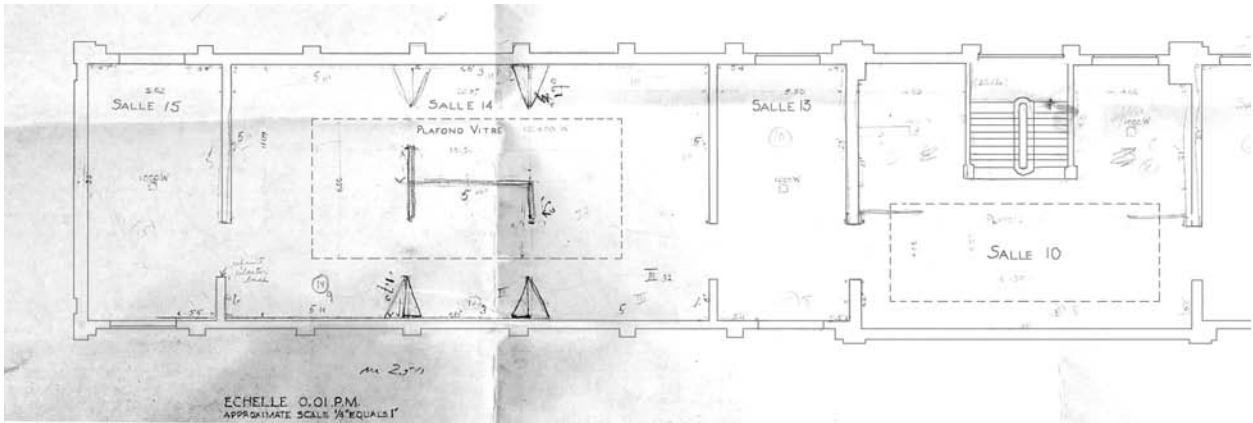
pianta del primo piano, impianto luci, 1938. Lato Louvre e corpo centrale. Archives
